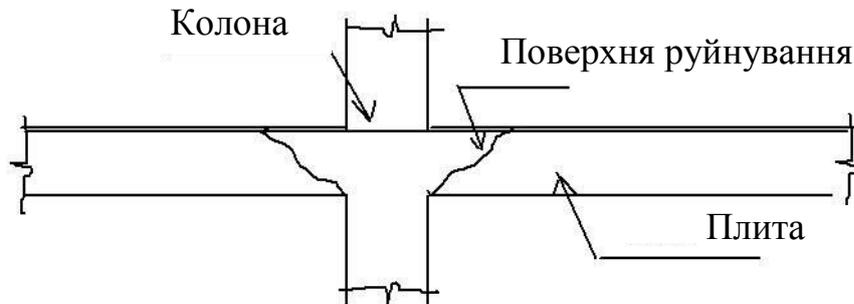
Схема для розрахунку залізобетонних елементів на продавлювання
